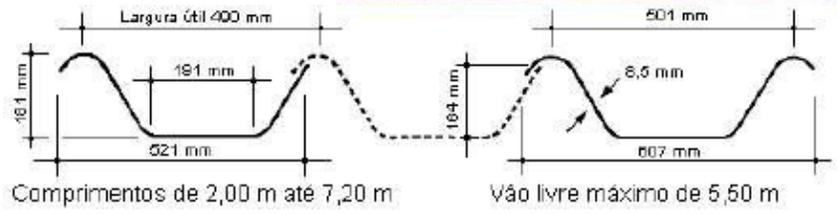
Telha autoportante de fibrocimento – modelo “Canaleta 49”.
